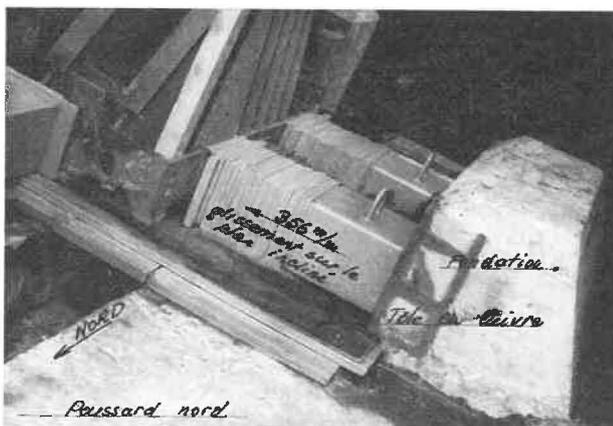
Poussard nord. Calages placés à la base du plan incliné après avoir fait glisser le poussard de 356 mm sur celui-ci.
